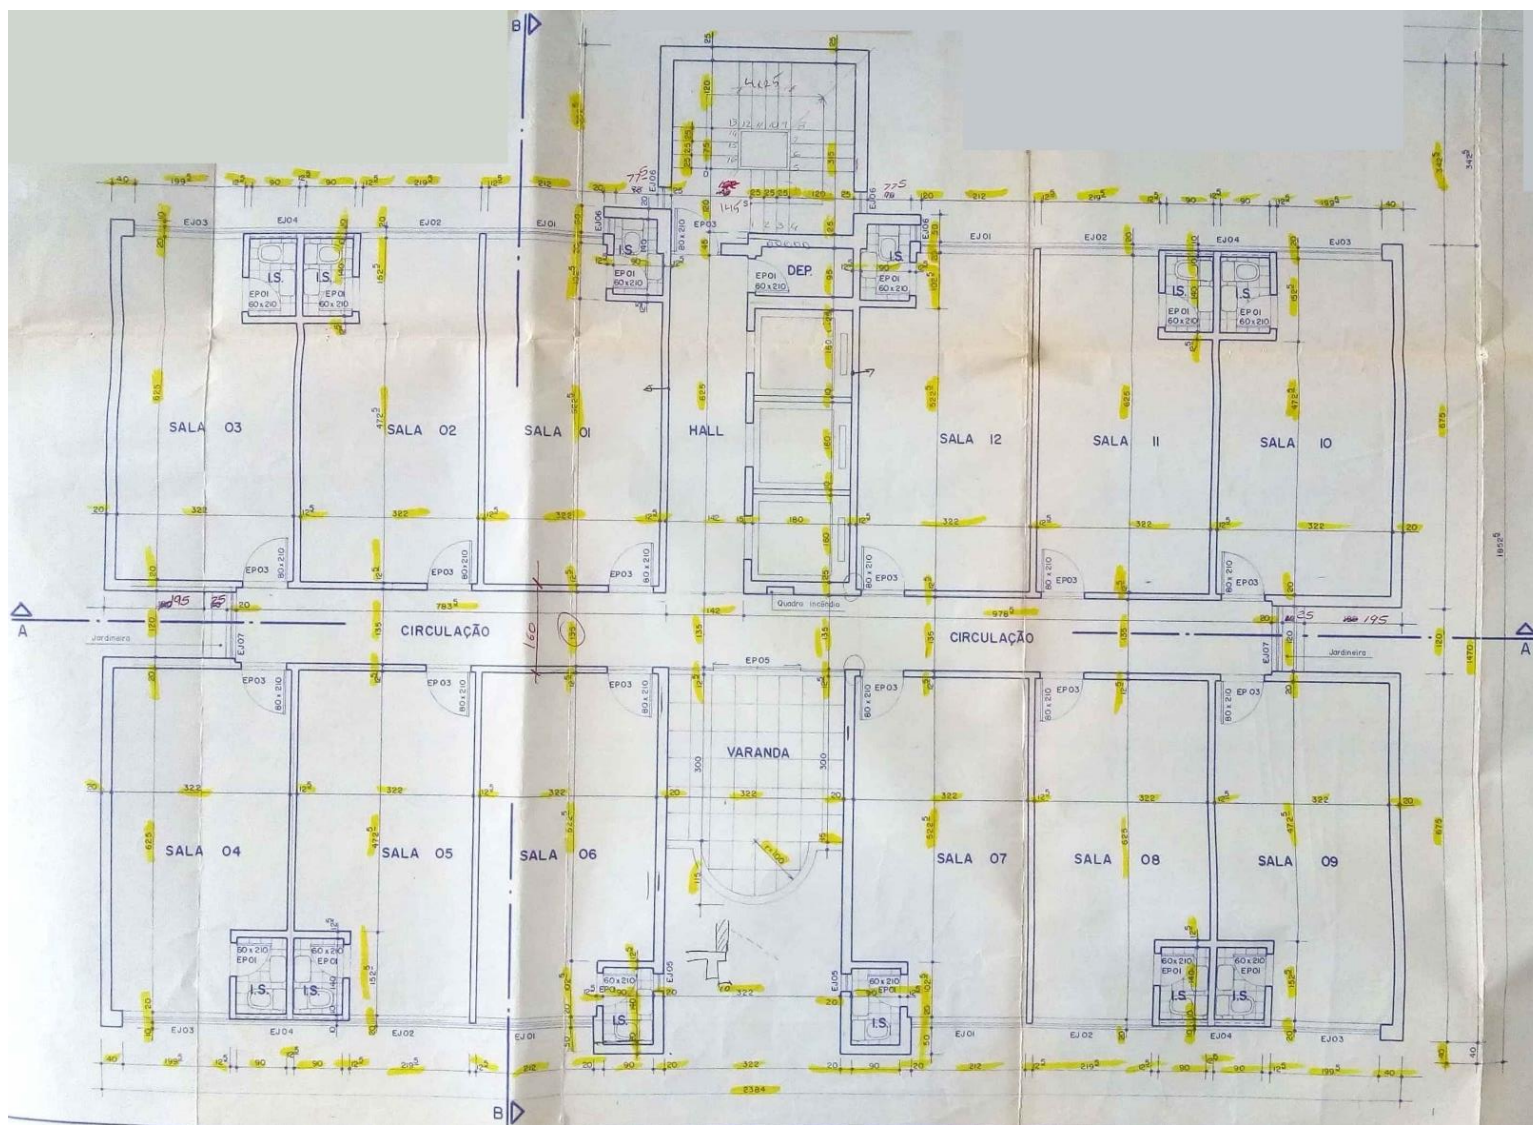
a – Planta do pavimento tipo (repete 11 vezes).
